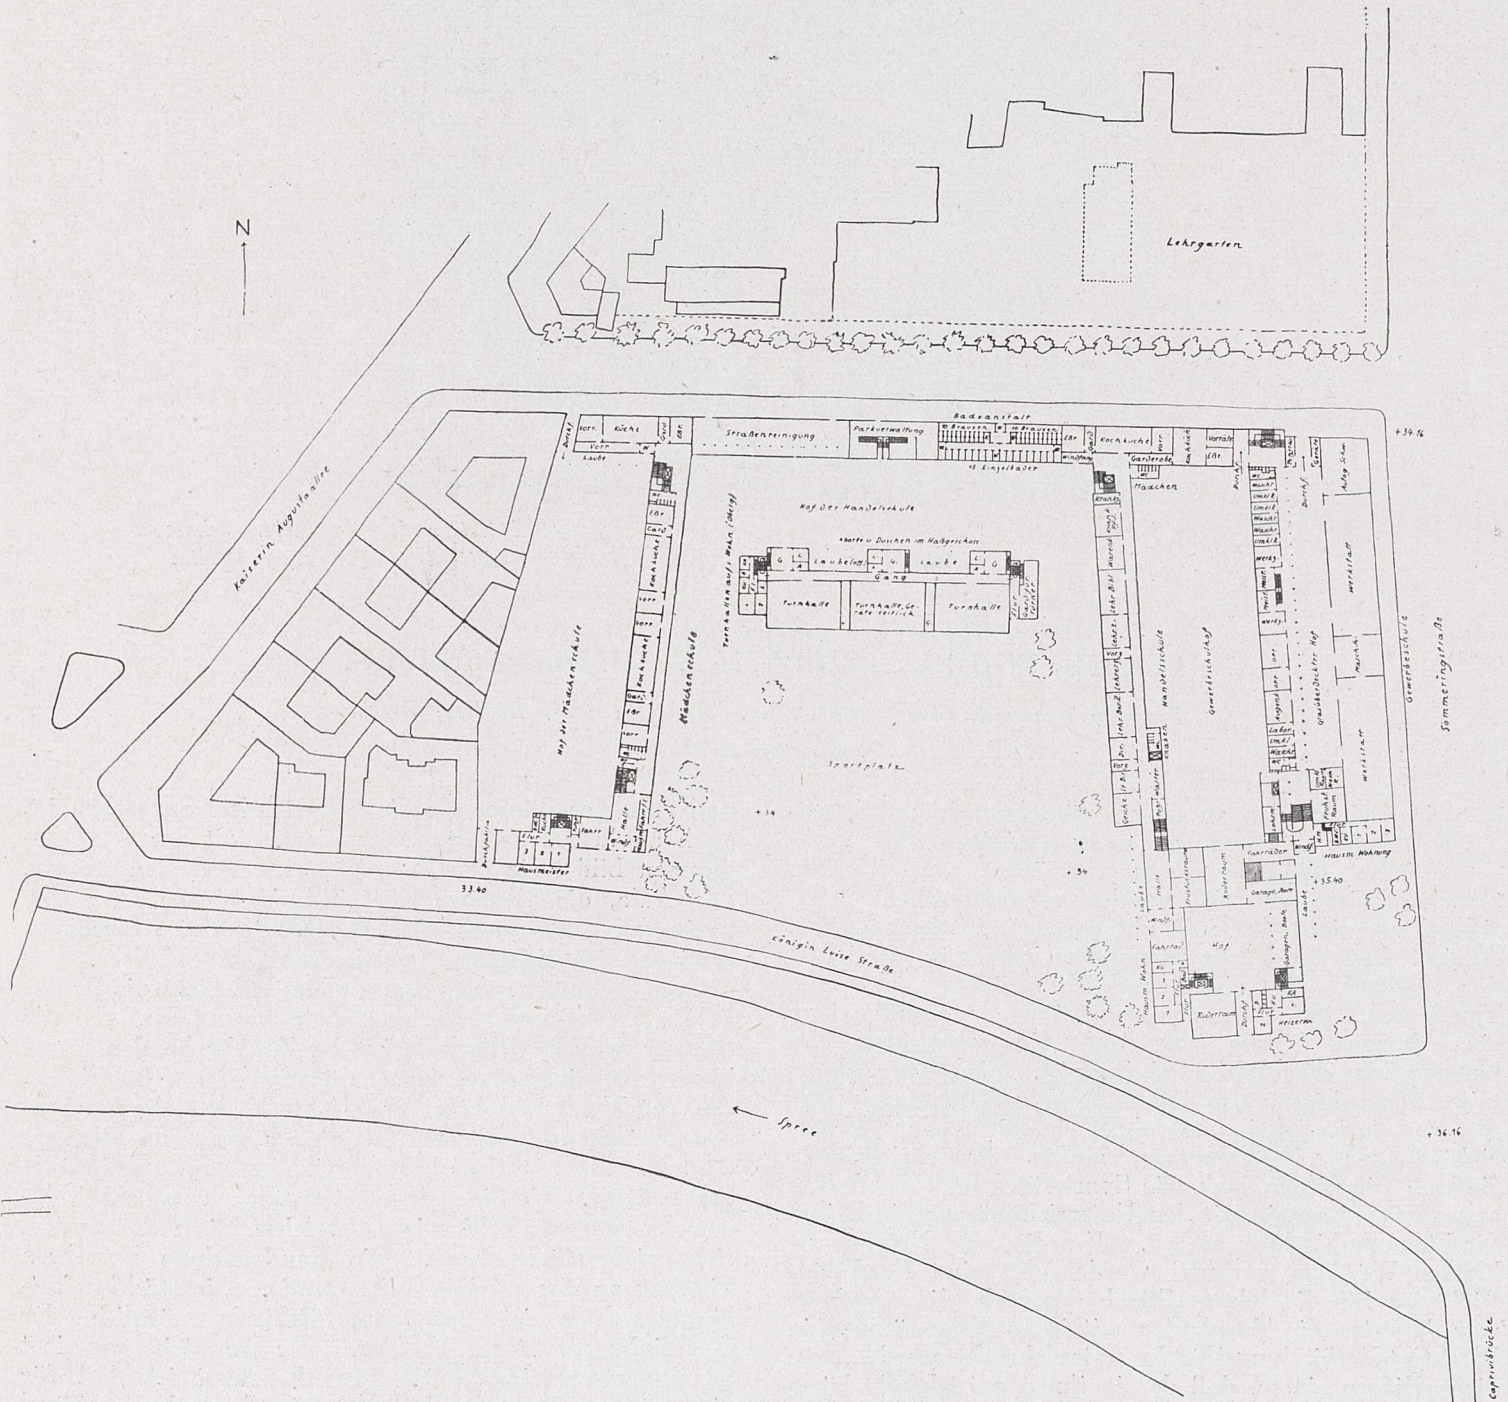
Lageplan mit Grundriß vom Erdgeschoß. M. 1:2000.
